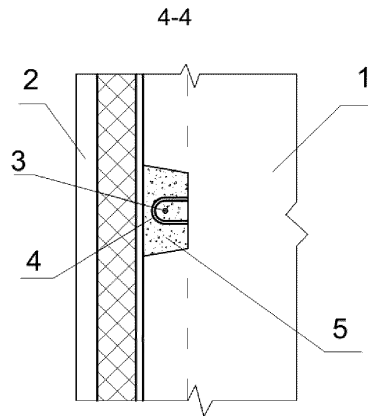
Фрагмент монтажной схемы, сечение 4-4: 1 – плиты перекрытия; 2 – стены; 3 – анкер из стены; 4 – арматурные выпуски из плит перекрытий; 5 – бетон
